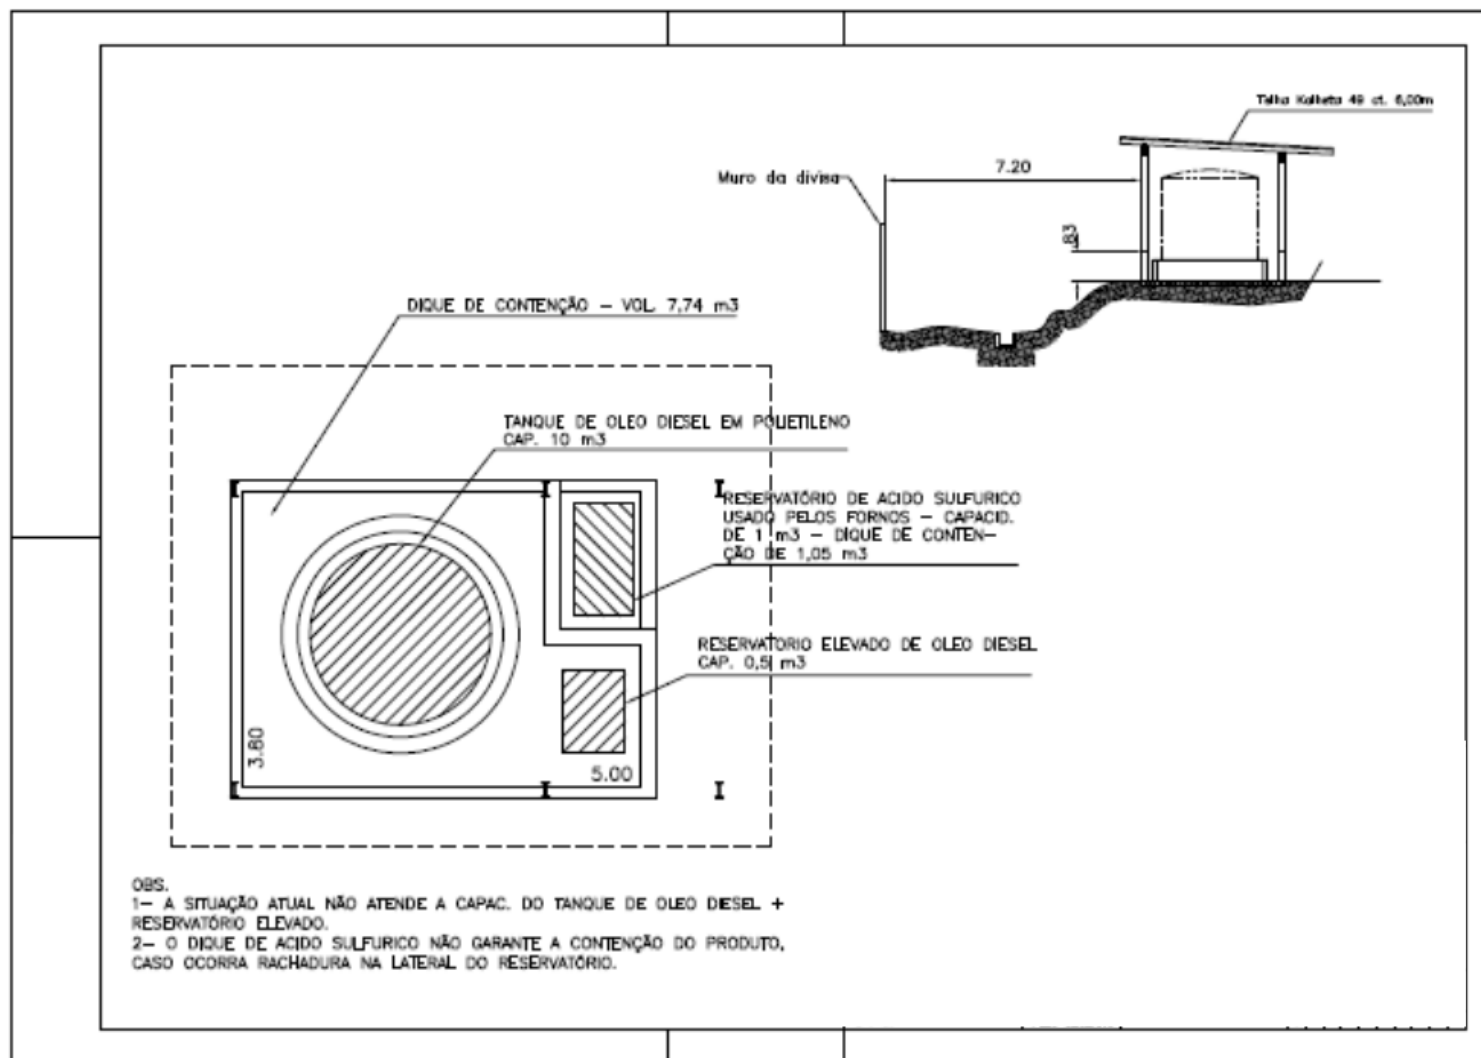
Planta baixa da área de armazenamento de óleo diesel (situação irregular)
